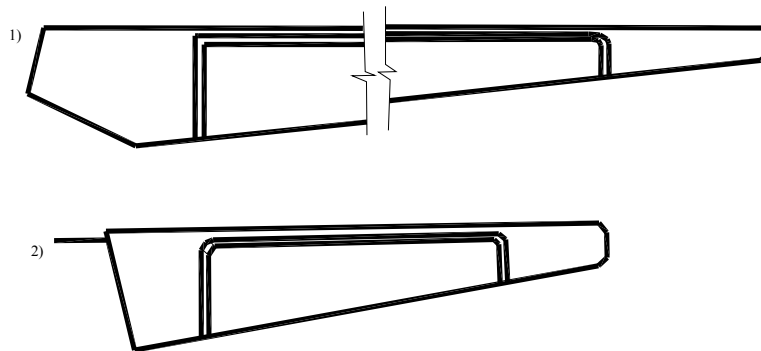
Елементи збірної піврами: 1 - ригель; 2- стійка
